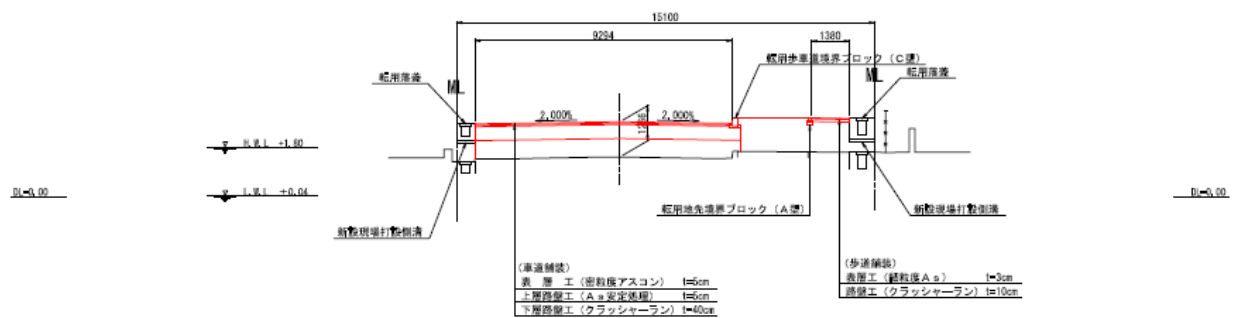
No.7 埠頭東路線標準横断面図（復旧後）
